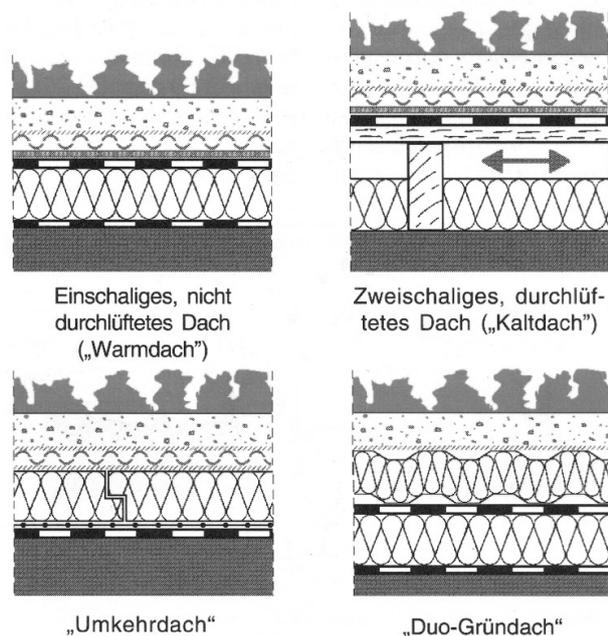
Dachkonstruktionsvarianten, Quelle: Zink, Das grüne Dach Standardwerk für Planung und Ausführung genutzter Dachflächen; Planungshilfe, Unterensingen 1998, S.11.
